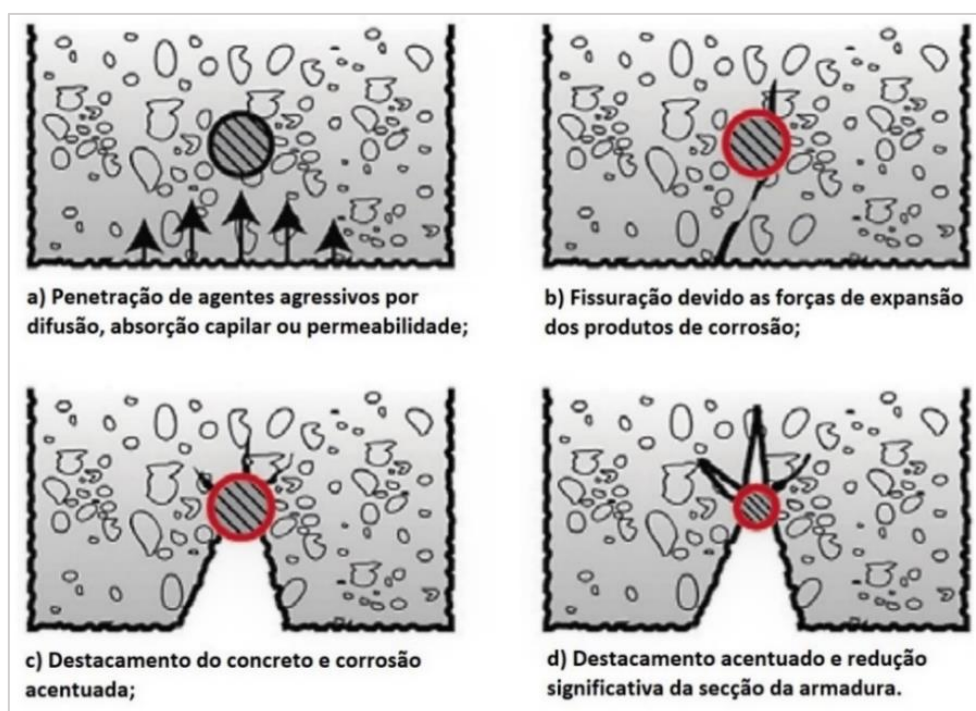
Ingresso dos agentes agressivos e esforços produzidos, que levam à fissuração e destacamento do concreto devido à corrosão de armaduras.
